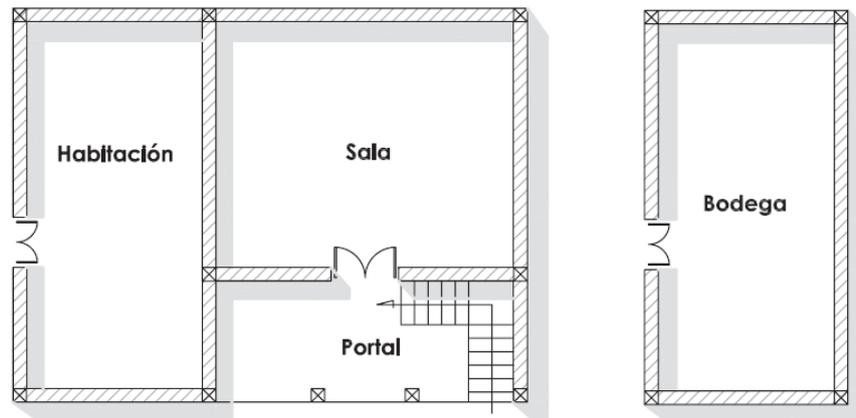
Socavón y Planta baja Vivienda Tipología 7
